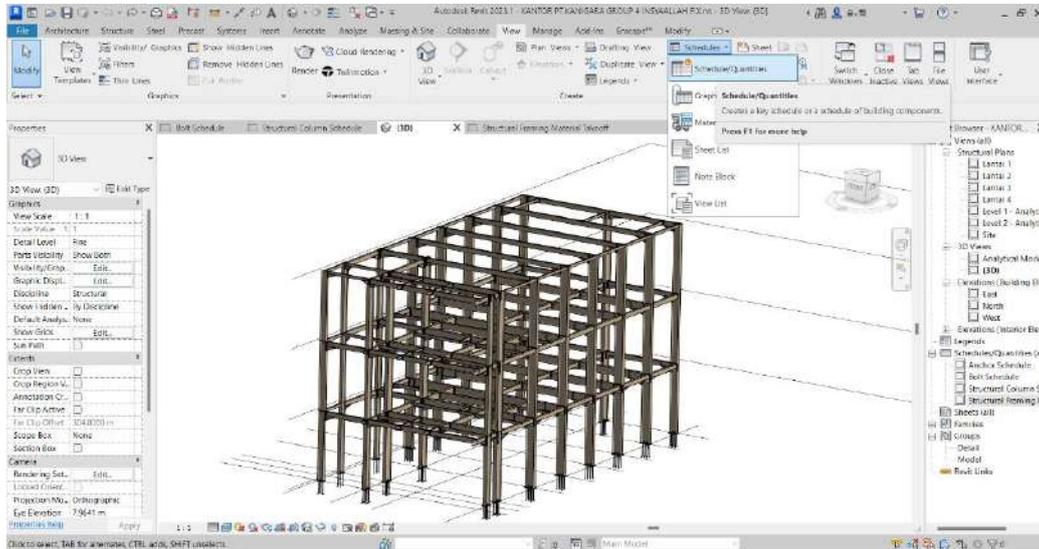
Hasil view modelling 3 dimensi struktur baja
